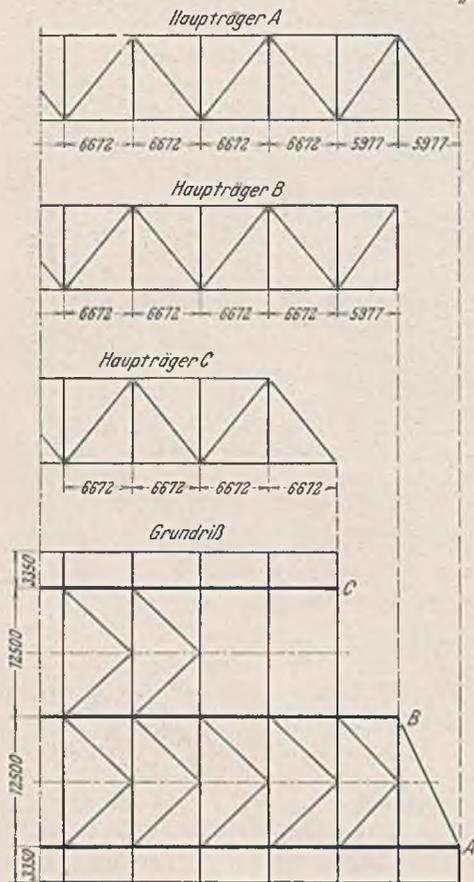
Feste Brücken. Feldweiten an den Brückenenden zum Ausgleich des Hauptträgerversatzes.
